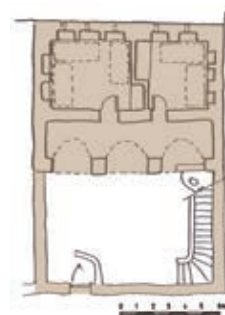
Einseitig bebautes Grundstück. – Oman, Sanaw, ländliches Hofhaus.
